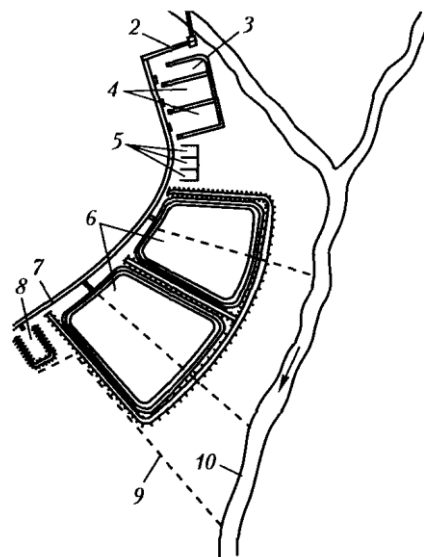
Схема расположения рыбхоза с механическим водоснабжением:
